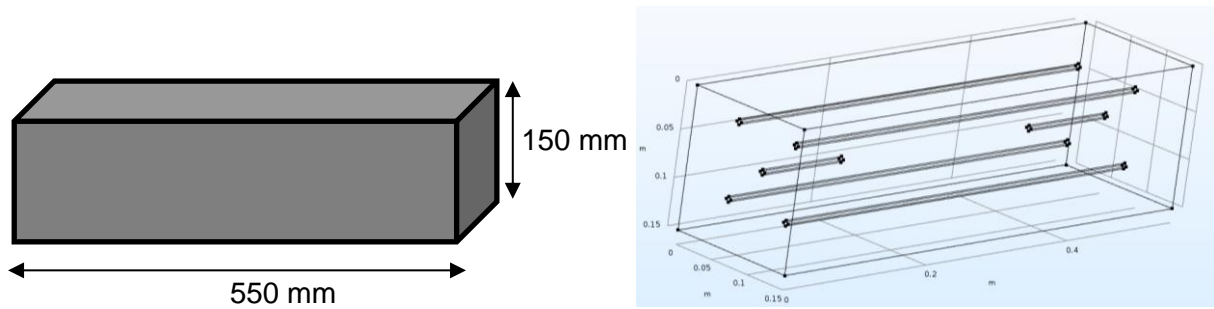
Schémas d'une poutrelle 150×150×550 mm
